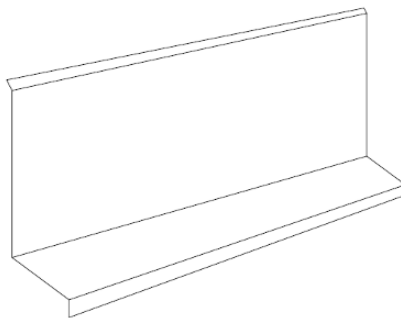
detalhe de pingadeira (rufo) metálica. Fonte: autor.
